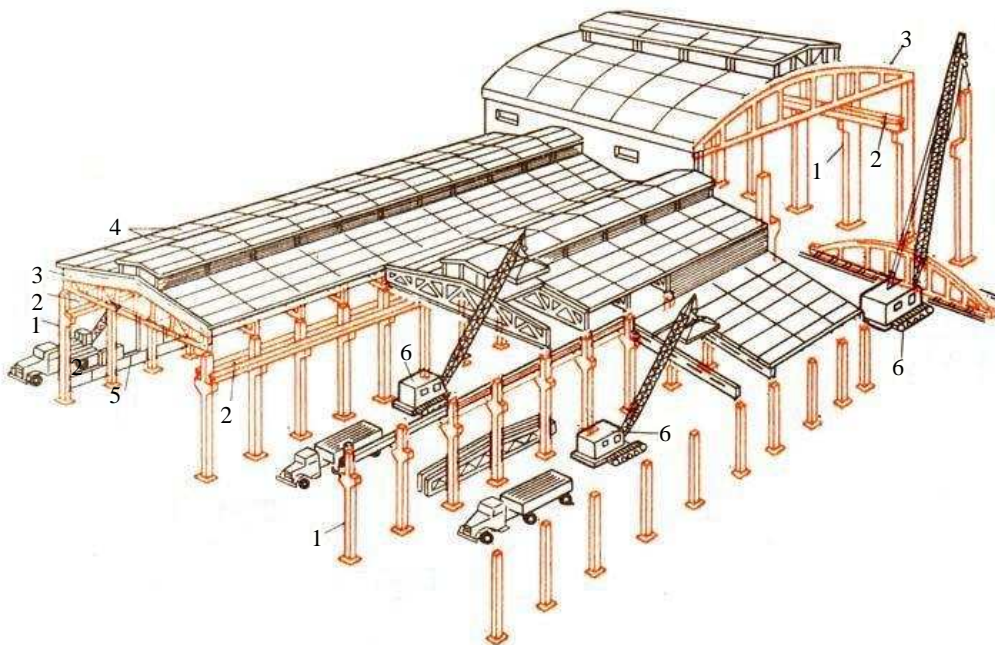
Схема поелементного монтажу залізобетонних конструкцій одноповерхового промислового будинку: 1 – короткобазовий кран; 2 – мостовий технологічний кран; 3 – автомобіль; 4, 9 – крани гусеничні; 5, 8 – ферми; 6 – балка; 7 – машина монтажна
